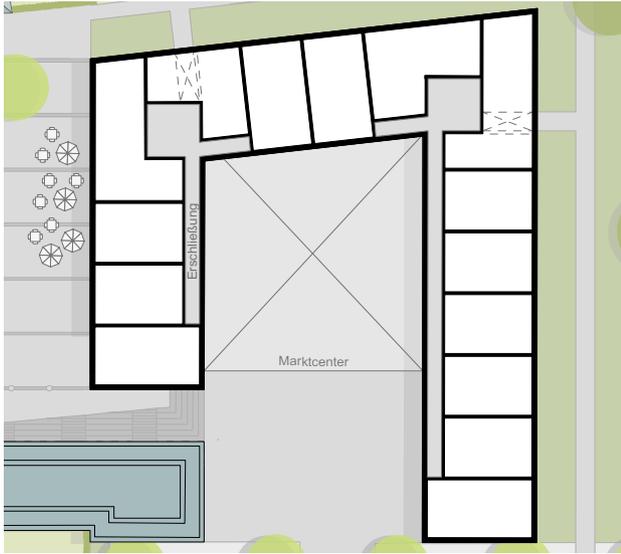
Grundriss Regelgeschoss ‚Marktcenter mit Wohnungen M: 1:800 (oben links)
